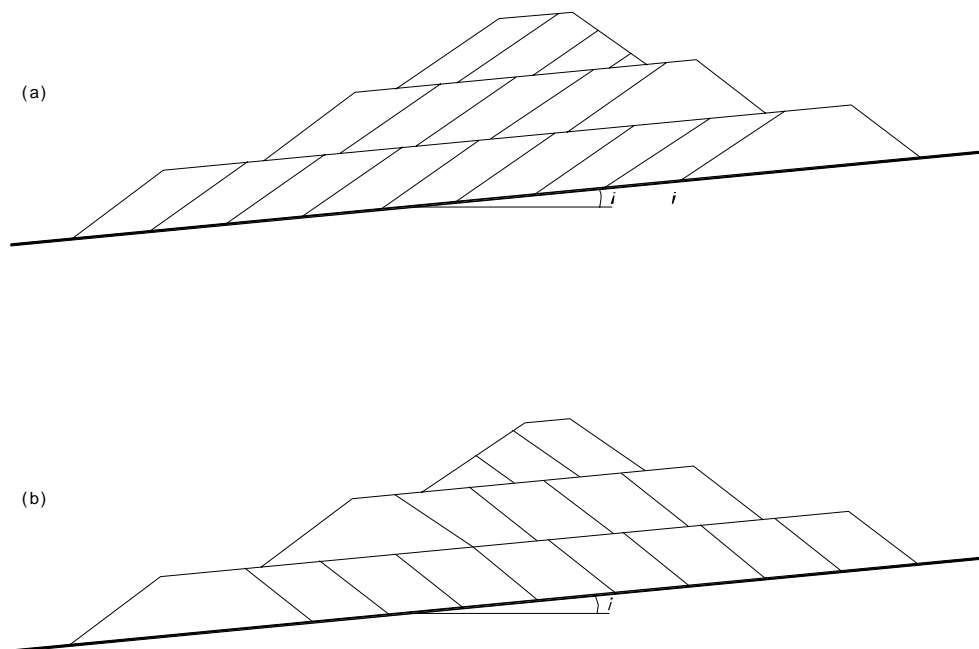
Planos internos en una pila de mineral: (a) apilamiento en la dirección pendiente abajo; (b) apilamiento en la dirección pendiente arriba.
